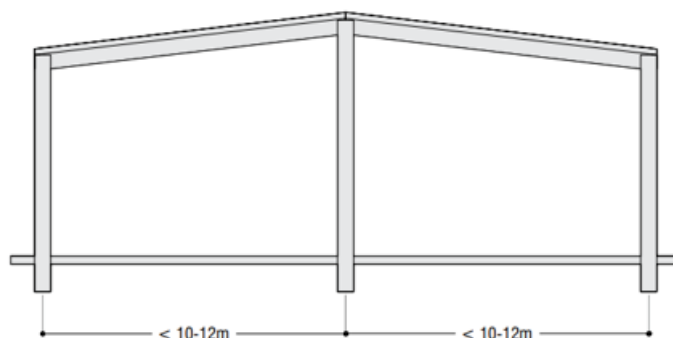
Restriccions pilars i jàsseres de façana. Font: Planas
